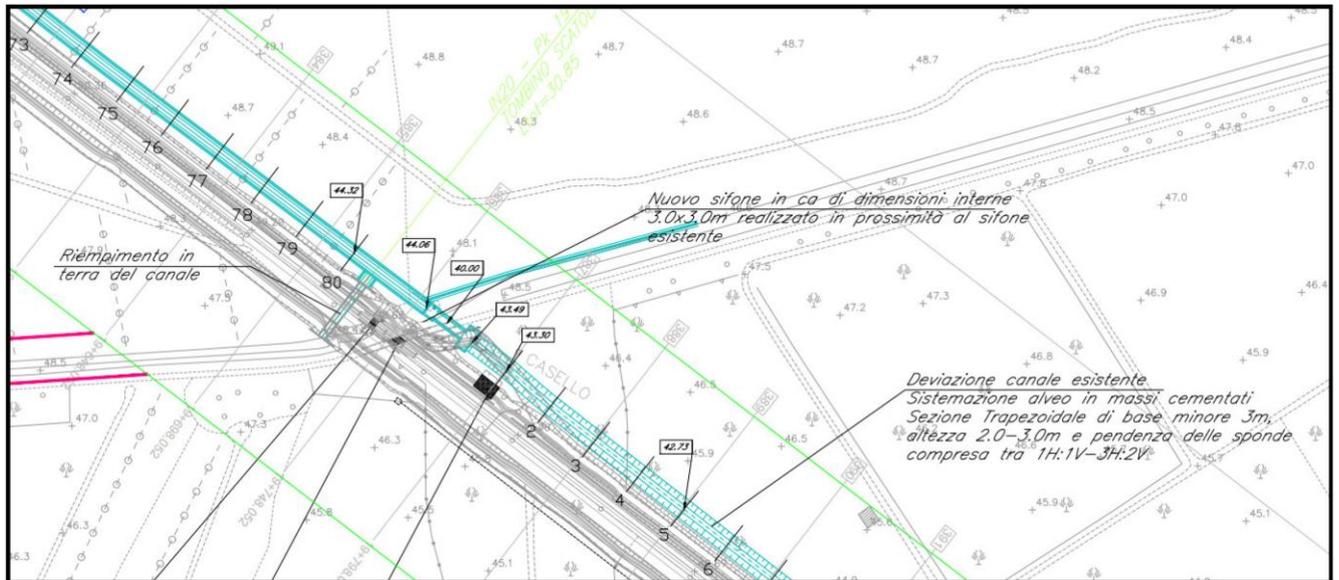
Stralcio planimetria di progetto – Identificazione sifone IN20
